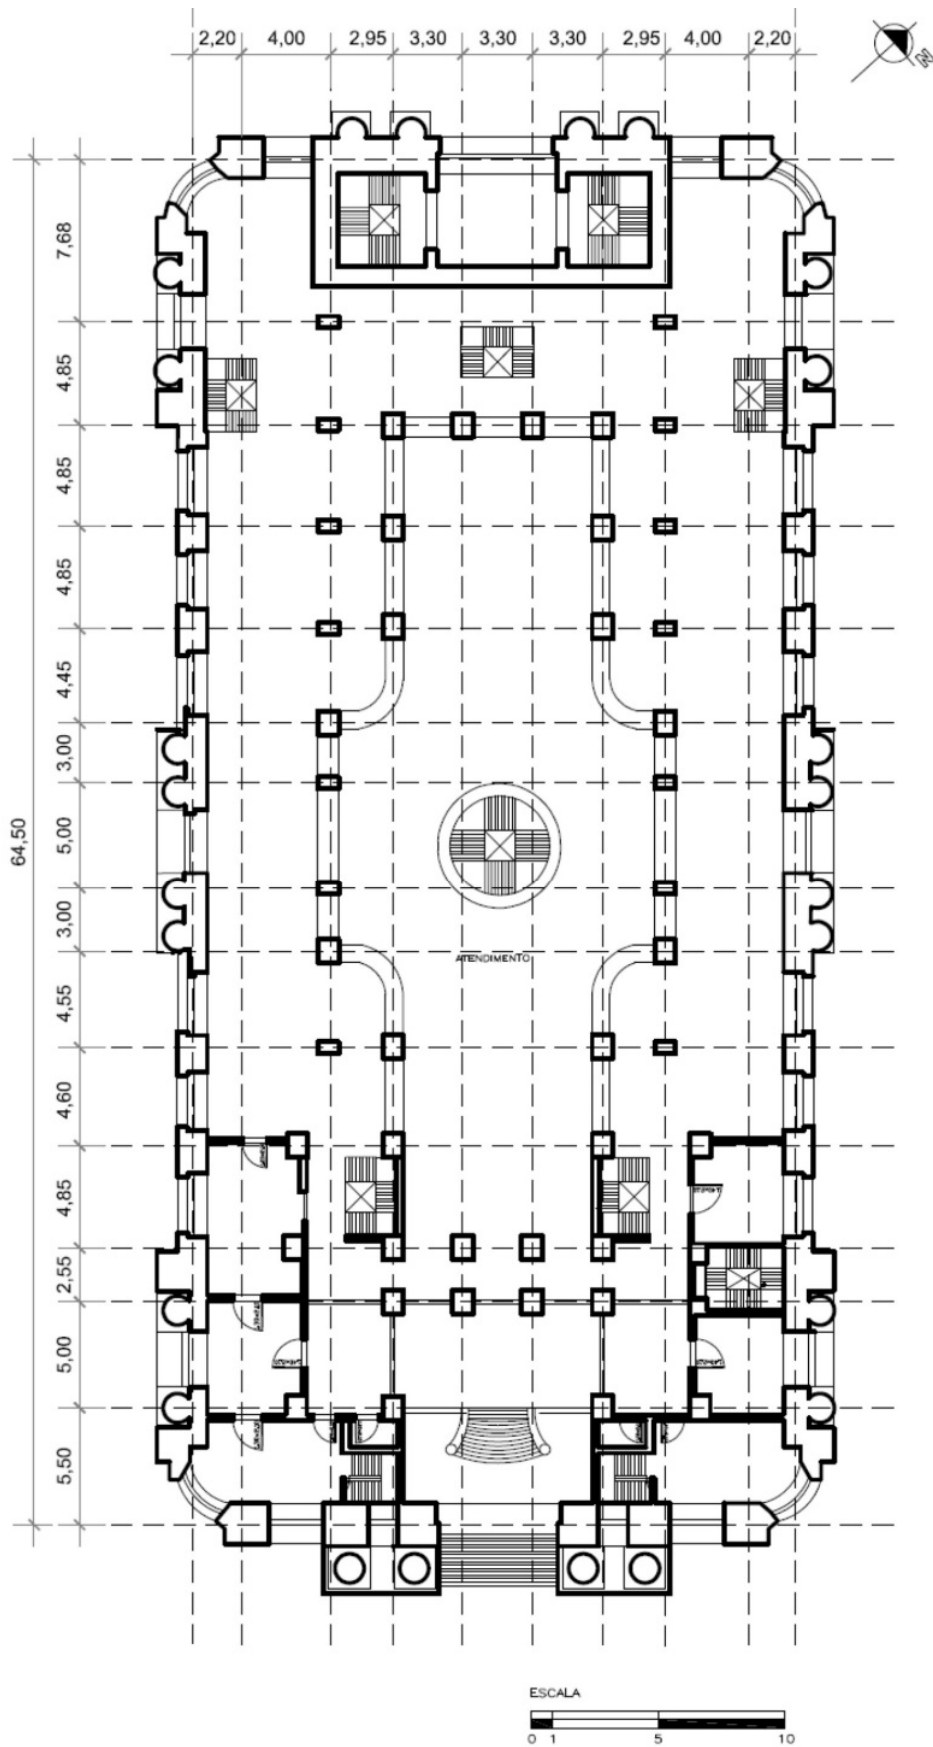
Modulação de projeto demarcada em redesenho da planta baixa térreo de Banco Nacional do Comércio (1931).
